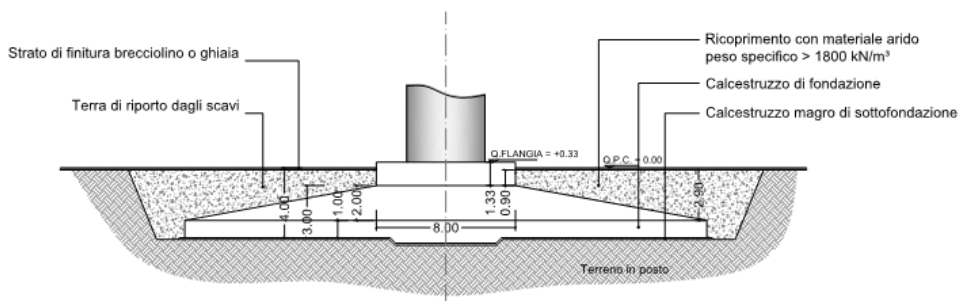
Pianta e vista della fondazione tipo dell'aerogeneratore in caso di fondazione diretta
